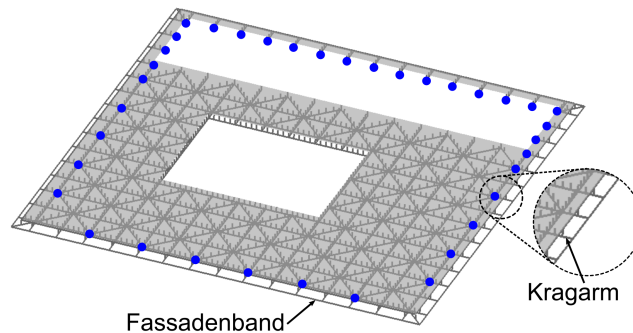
Dachkonstruktion: Beplankter Trägerrost aus Holz mit Kennzeichnung der betrachteten Auflager (blaue Punkte)
